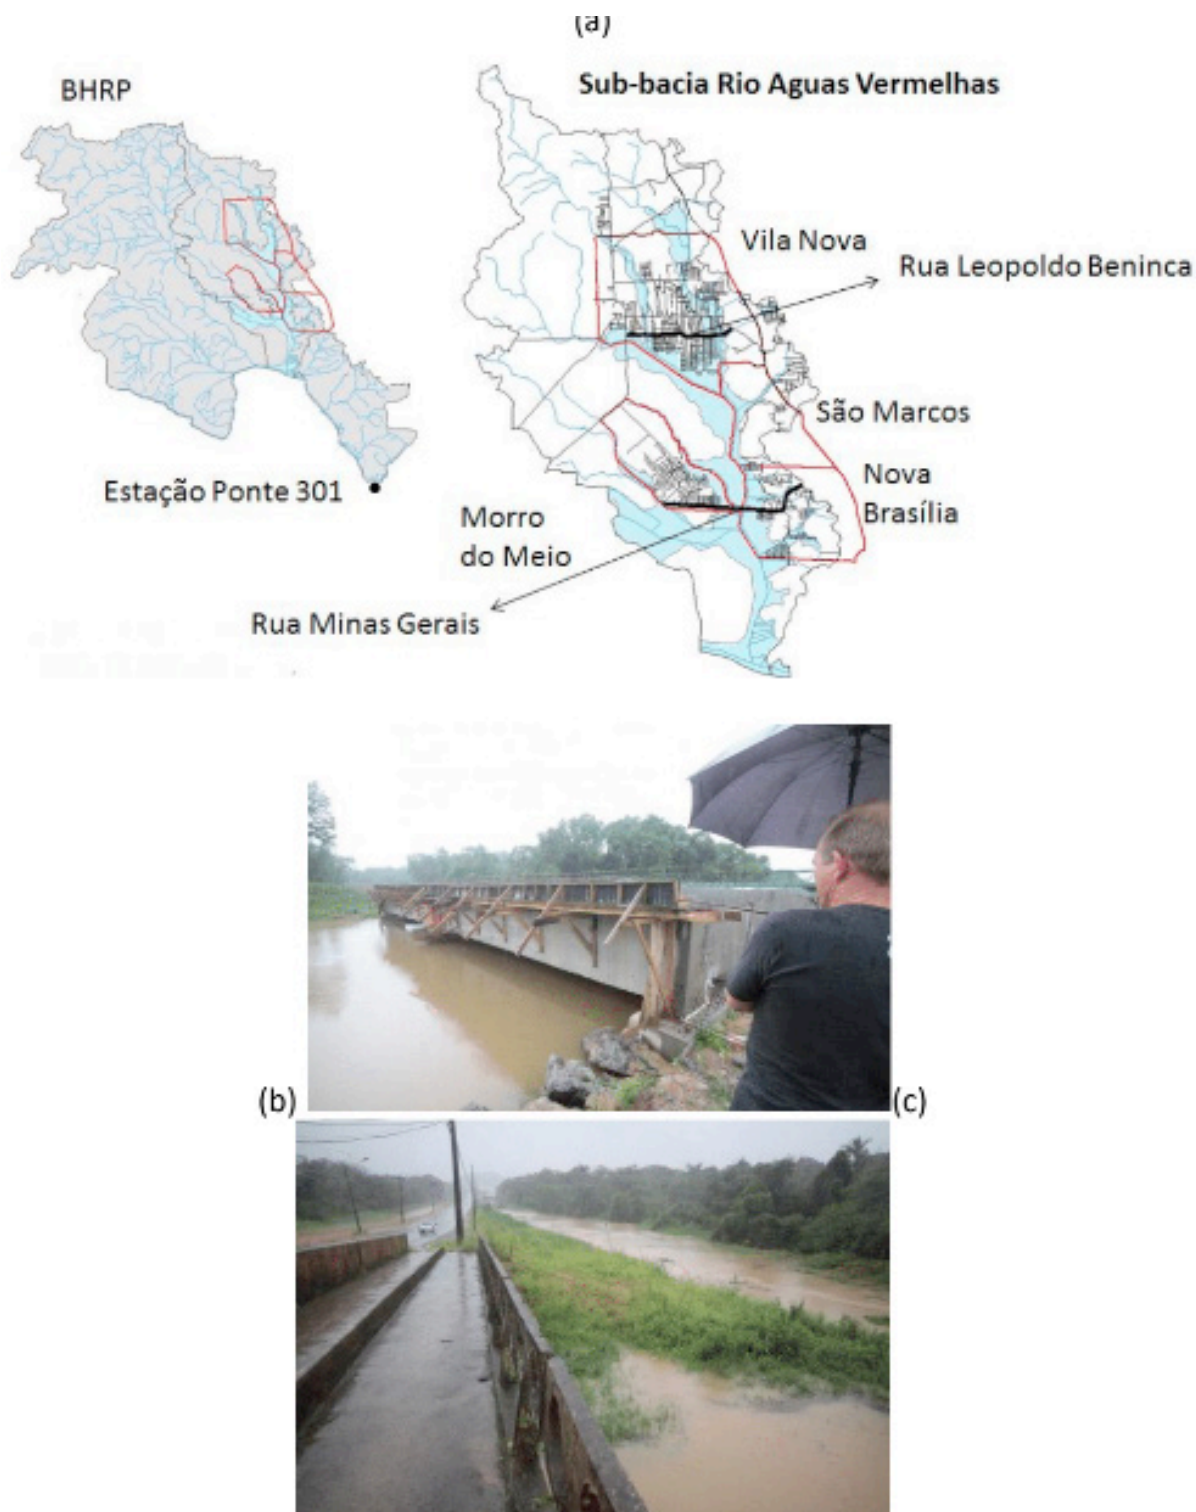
Obras no (a) Localização das bacias (b) Construção da Ponte sobre o Rio Águas Vermelha e (c) Rua Minas Gerais (Fonte: NOTÍCIAS DO DIA, 2014)
